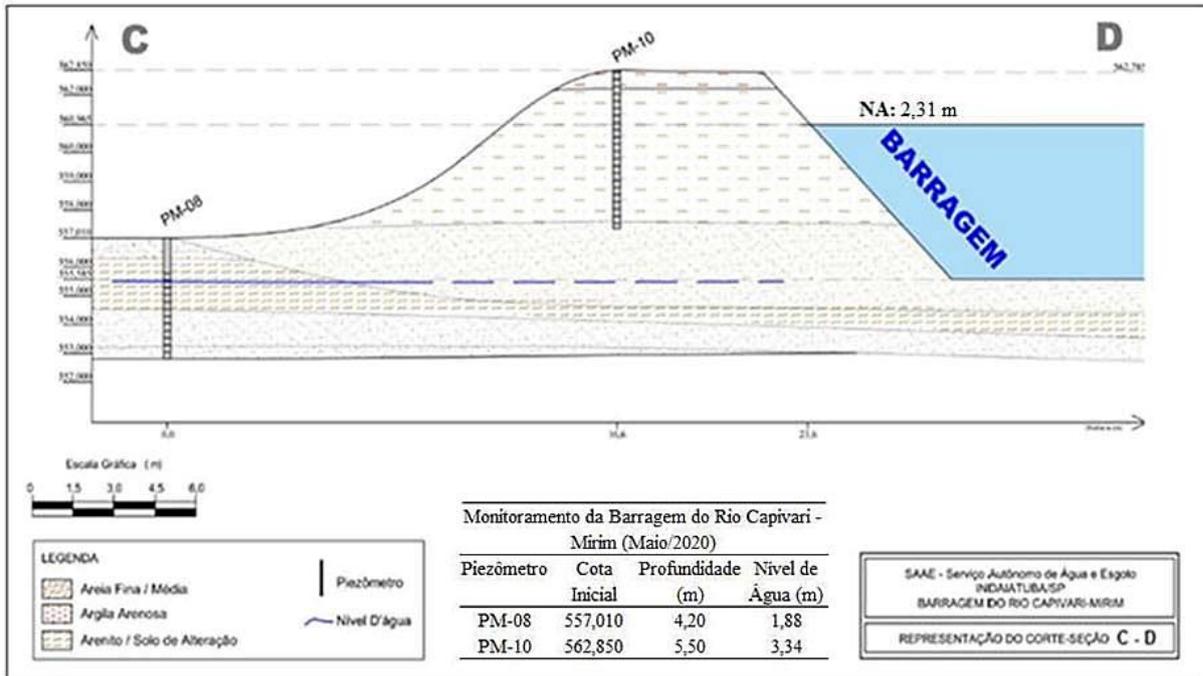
Esquema de instalação dos piezômetros da Seção C-D
